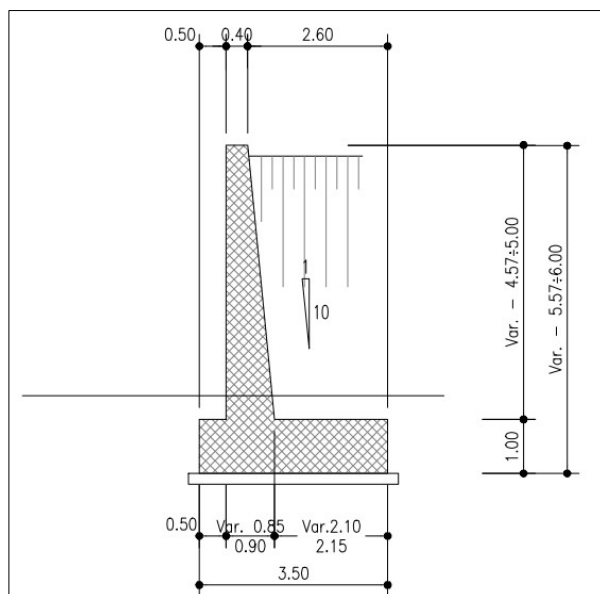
Sezione trasversale del muro d'ala – Lato Nord
